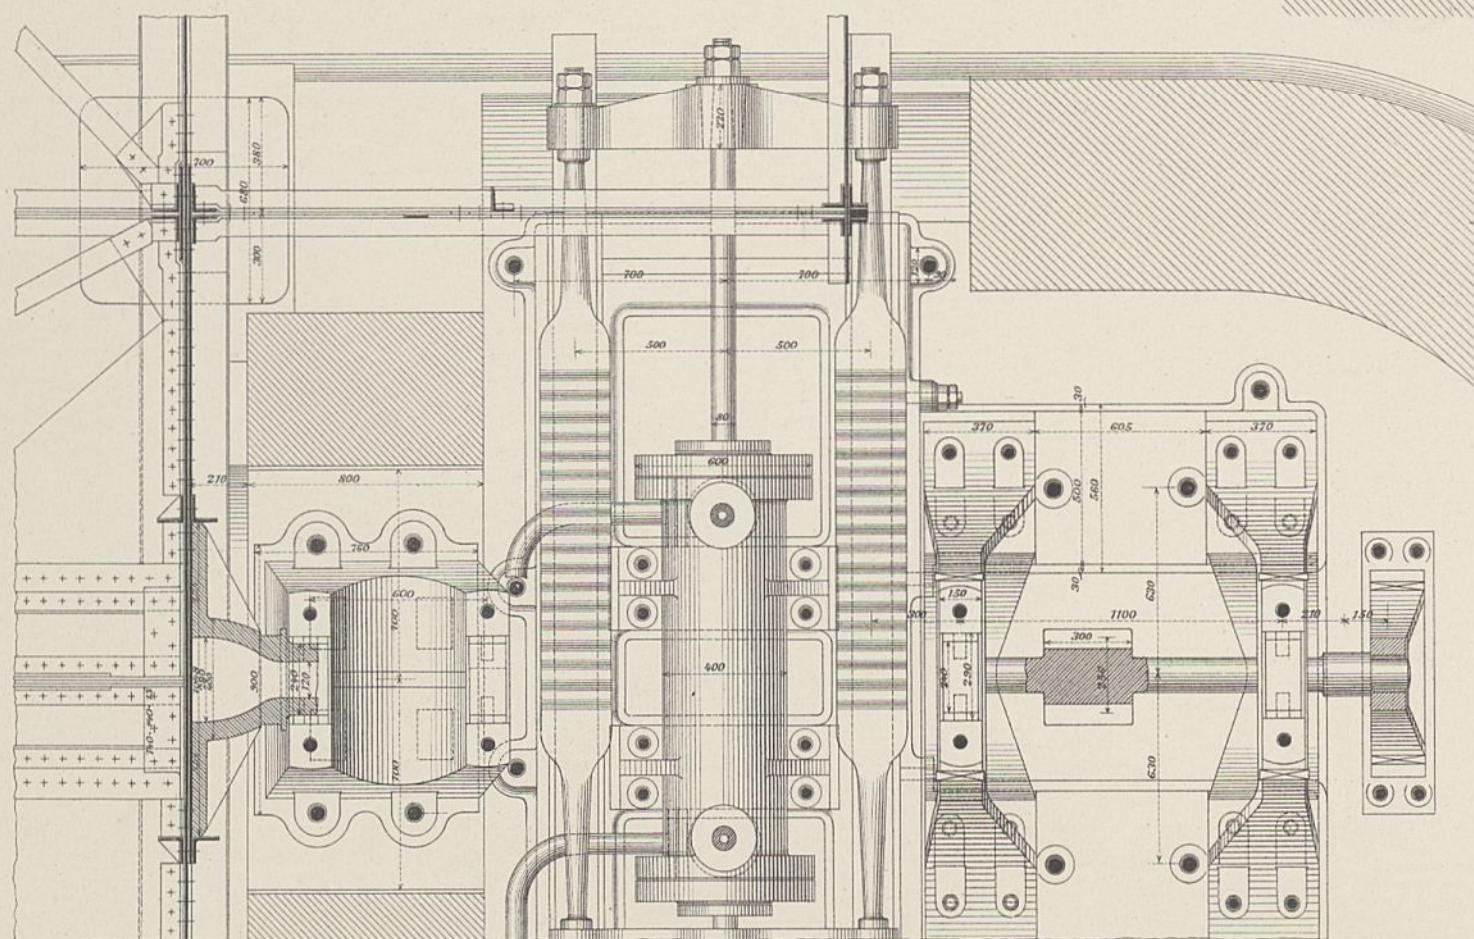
Grundriss des Pfeilervorkopfes.
